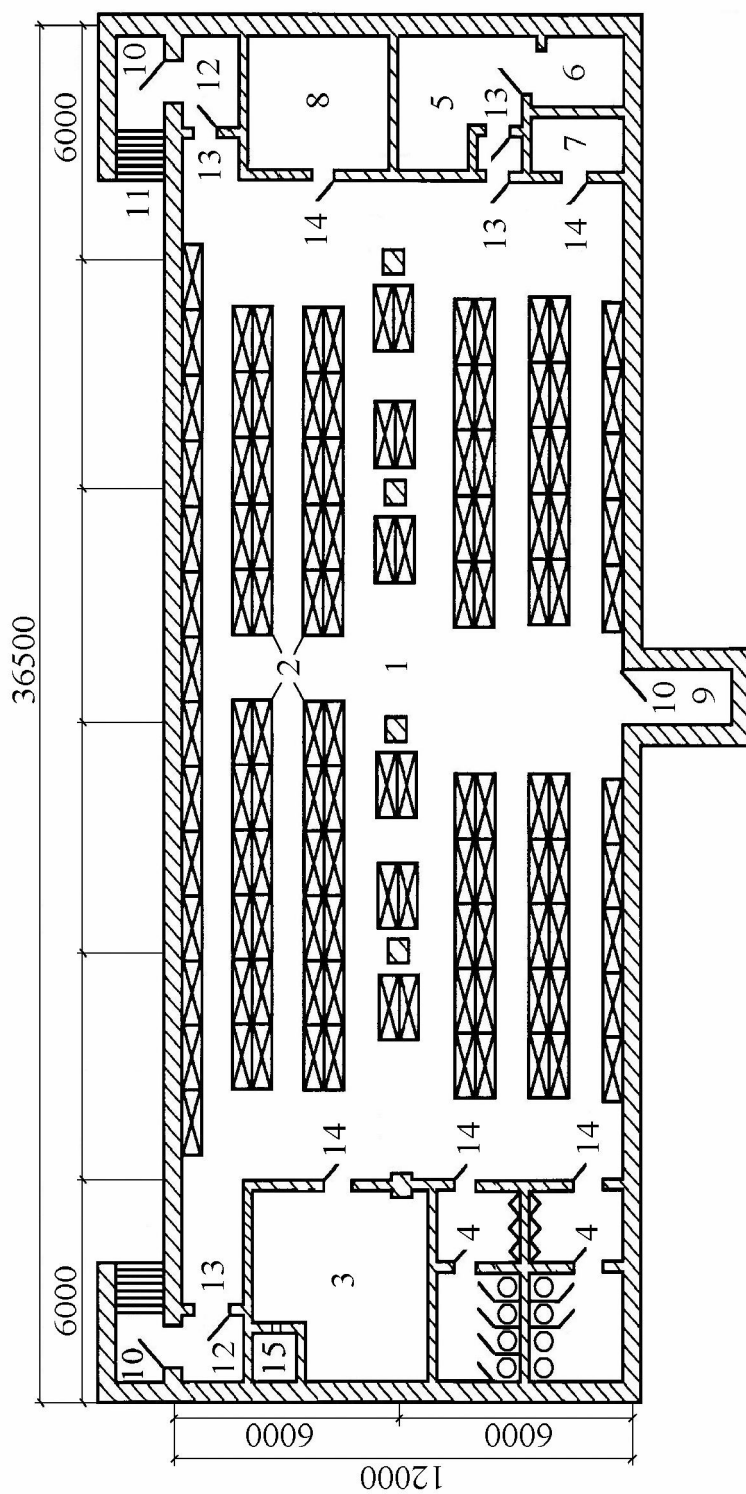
Планировочное решение встроенного убежища на 600 человек:
